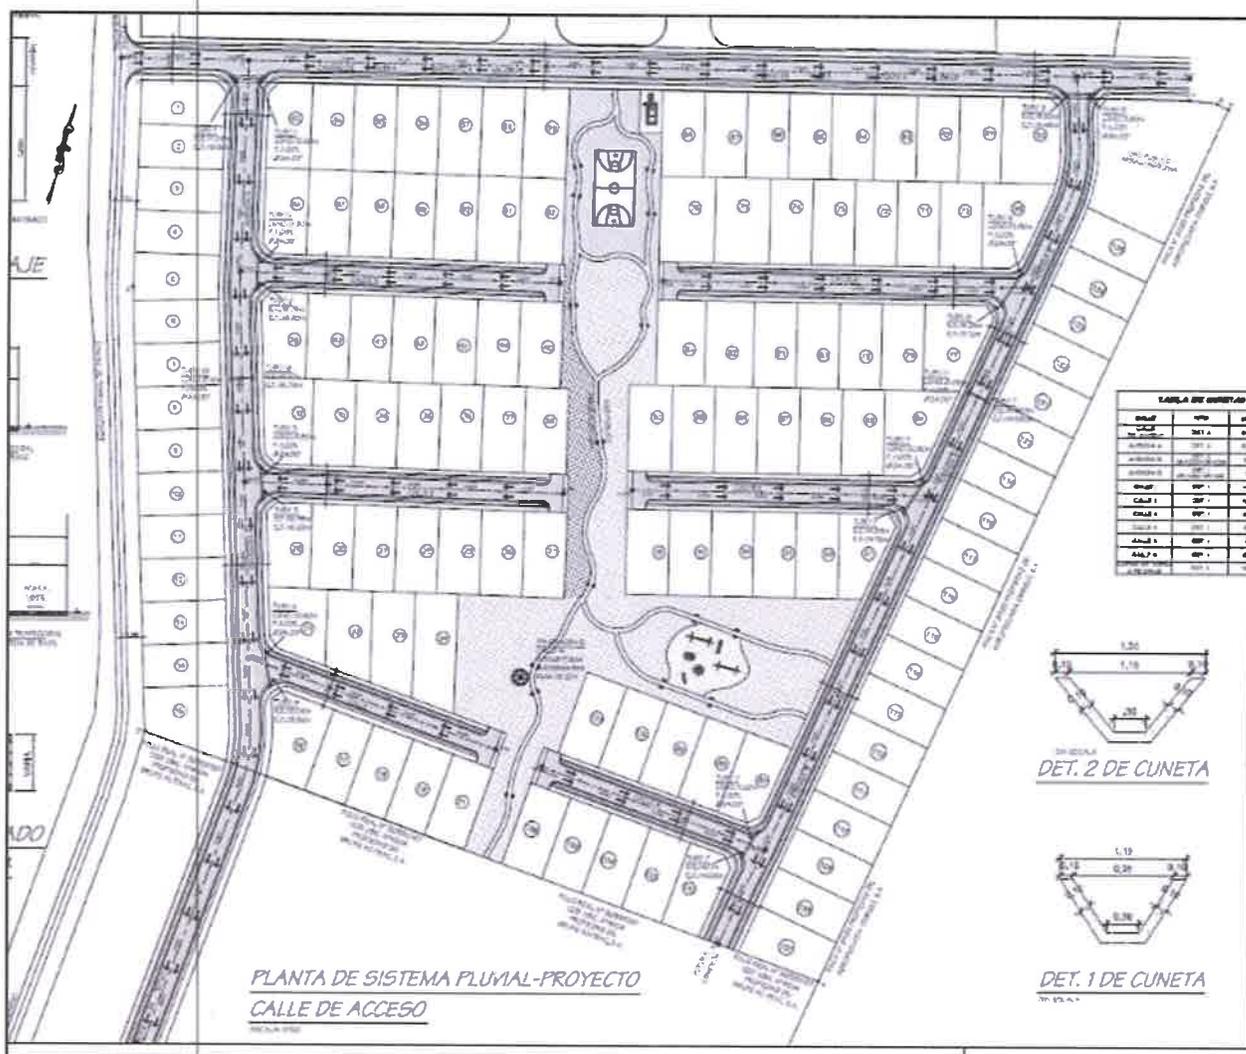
Fuente: detalle extraído de la hoja de plano 11 de 19 – Planta del Sistema Pluvial del Proyecto Residencial Santa Rita.
